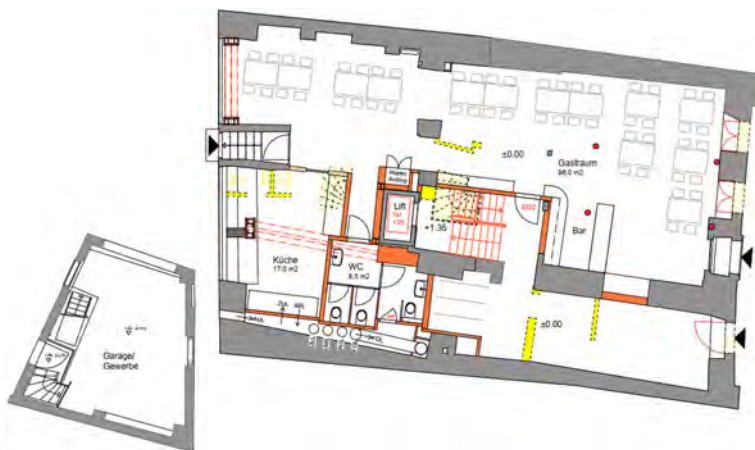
Grundriss Erdgeschoss [Verfasser unbekannt, Stand 28.04.26]
